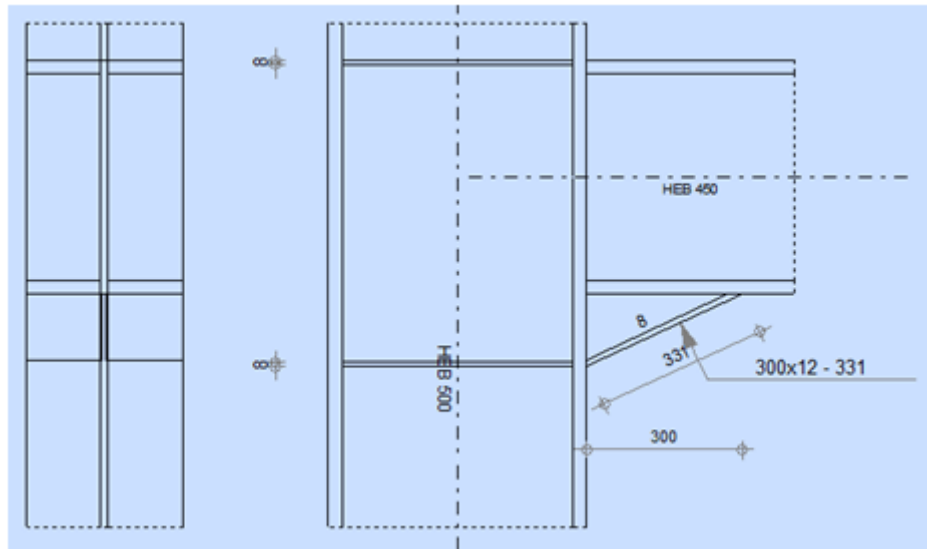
Dimensions de l'assemblage poteau-corbeau
